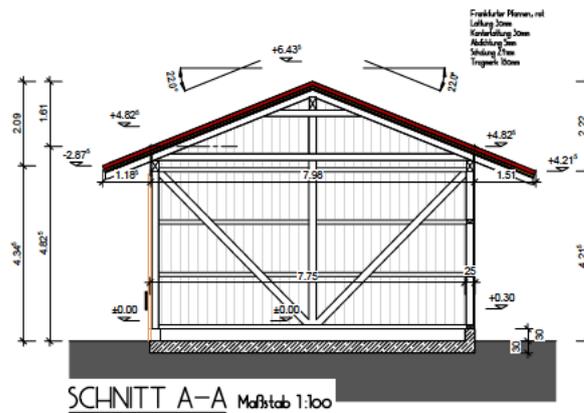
Schnitt Vereinestadel, Planstand: Eingabeplan 07.01.23
